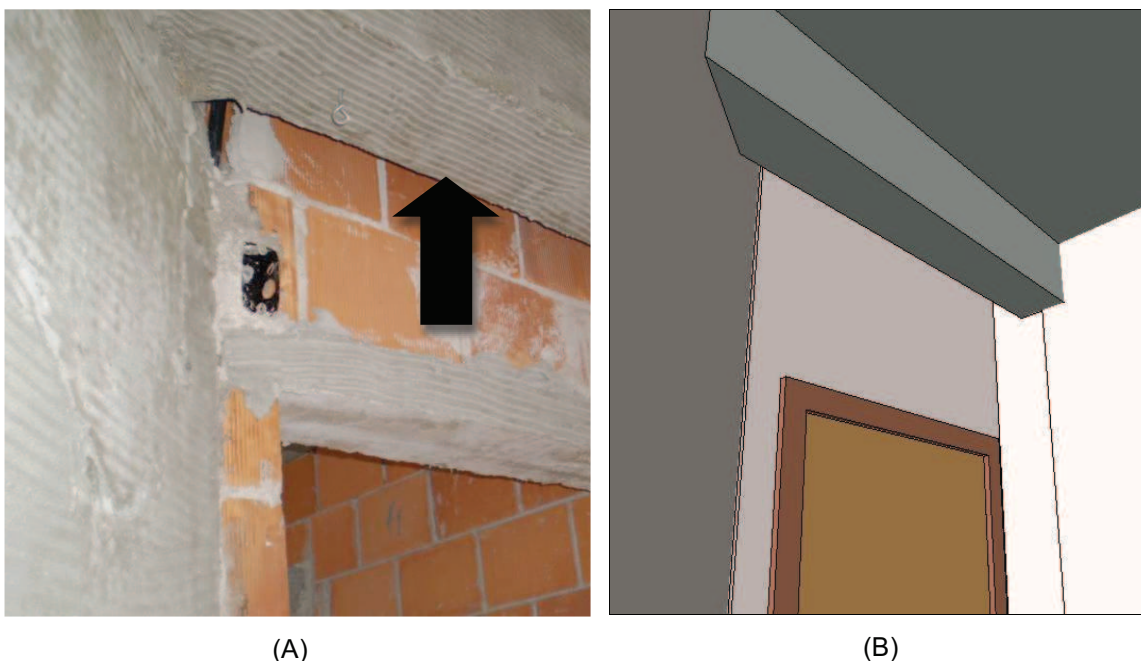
Fotos do hall de entrada dos apartamentos tipo
